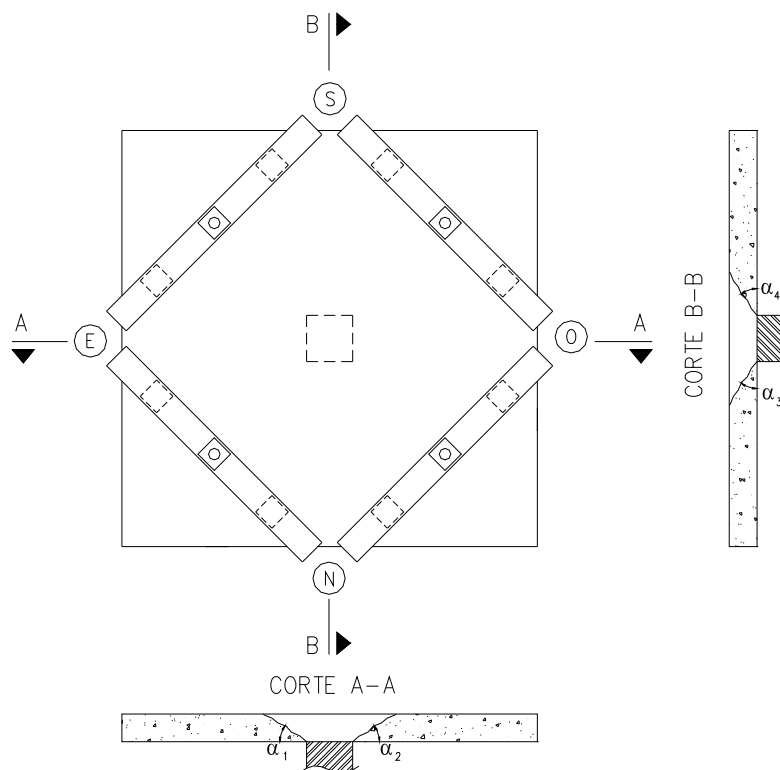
Inclinações da superfície de rotura com a horizontal
